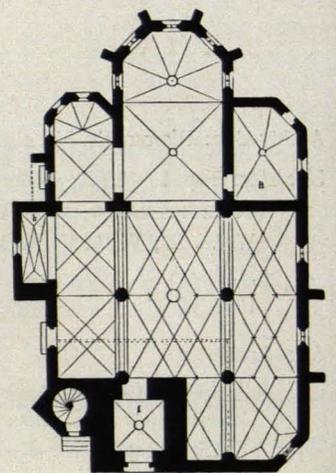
Hollenburg, Pfarrkirche, Grundriß 1:500 (S. 169)
